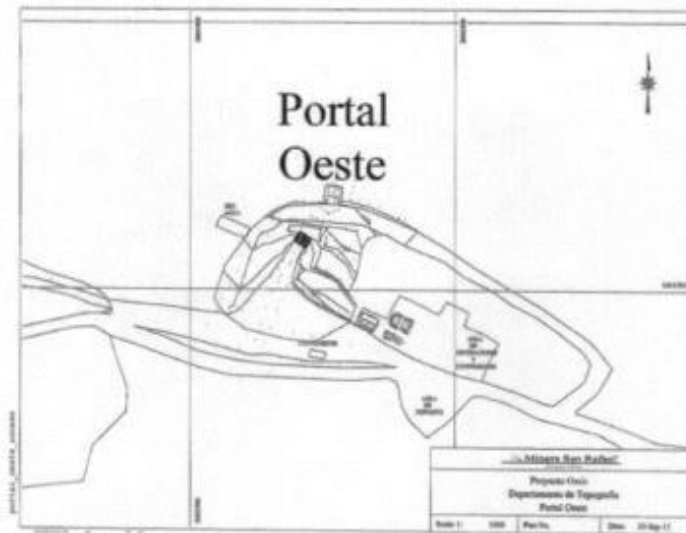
Plano de ubicación y área de construcción del Portal Oeste.
